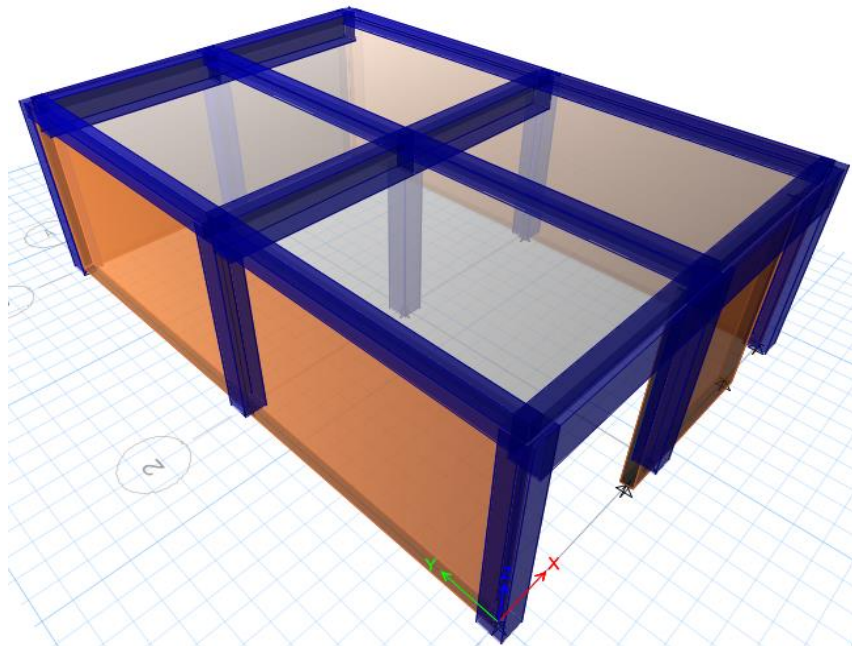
Modelamiento de la Estructura en Planta. Vivienda 02*Figura 34*Modelamiento de la Estructura en 3D. Vivienda 02
